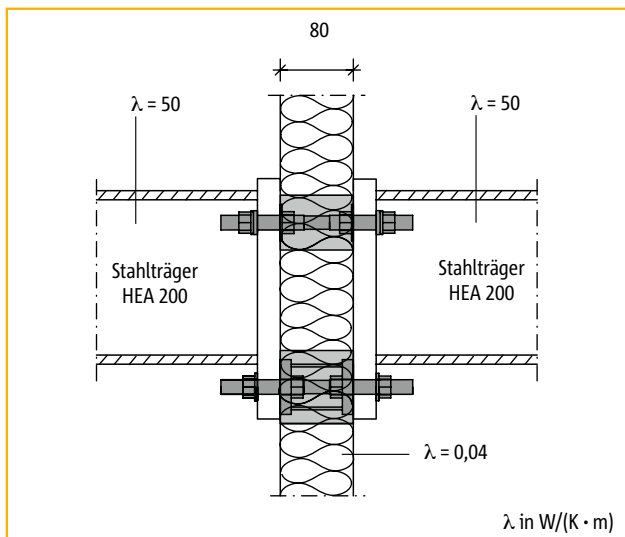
Anschluss-Stahlträger HEA 200 mit Schöck Isokorb® Typ KST16
